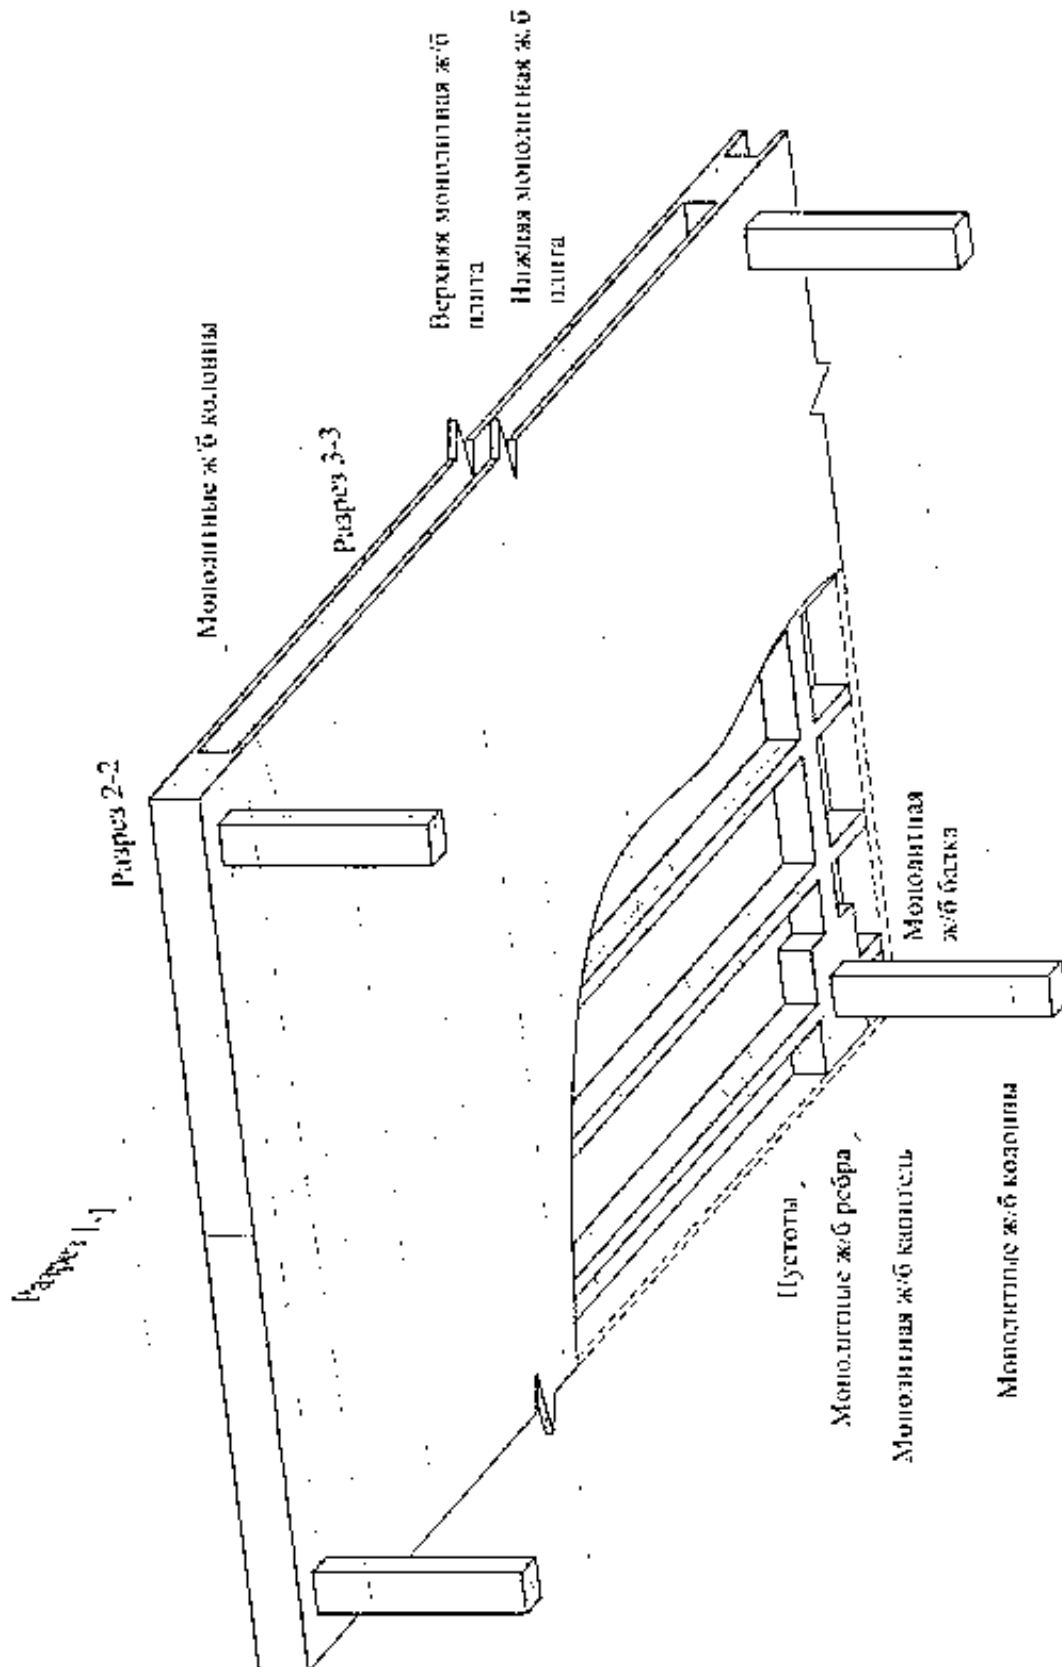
Безригельный преднапряженный каркас с пустотным перекрытием (дозволяє отримати приміщення площею  $185 \text{ м}^2$  і більше з абсолютно вільної планувальної схемою).
